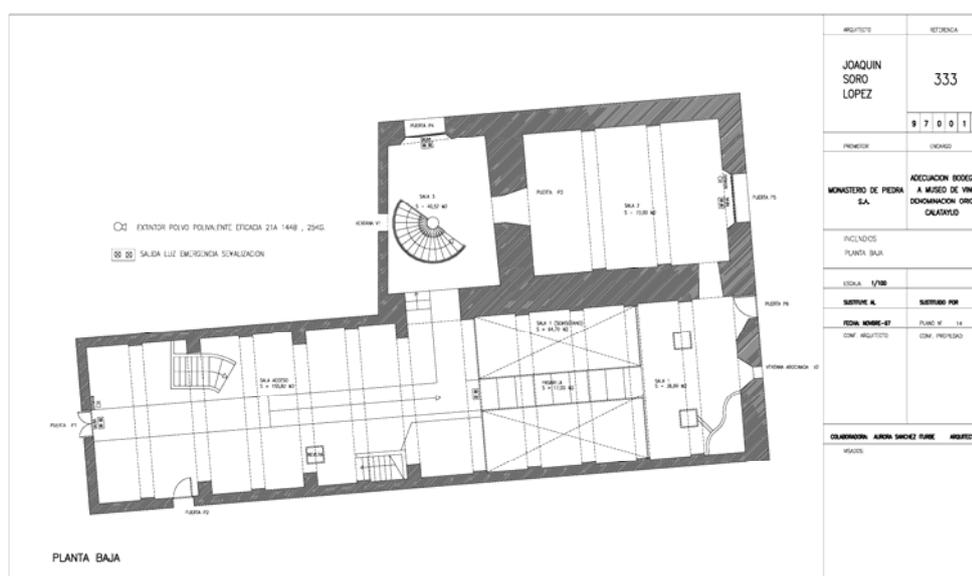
([AJS] Proyecto Nov 1997, plano 14) INCENDIOS. PLANTA BAJA.
